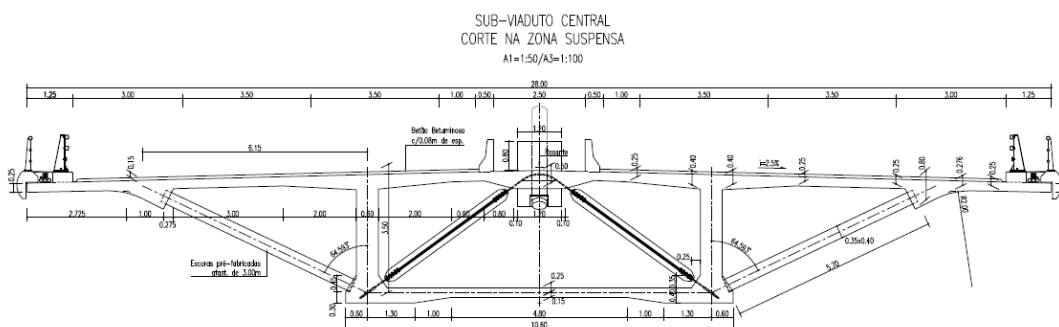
4 – Secção transversal do sub-viaduto central na zona suspensa (AutoestradasXXI et al. 2010b).
